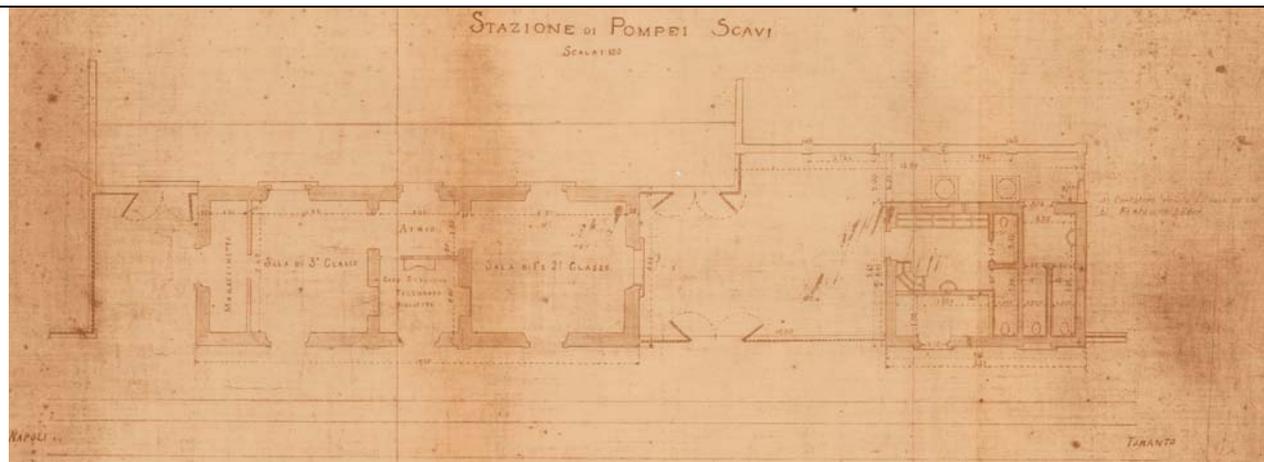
planimetria dei fabbricati della Ex fermata di Pompei scavi - fonte archivio storico FS
